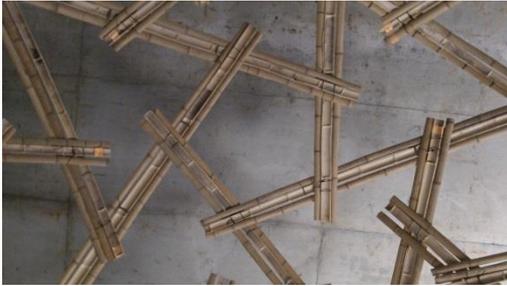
e 250 – Estrutura primária pronta e adensamento da estrutura iniciado pelo topo
